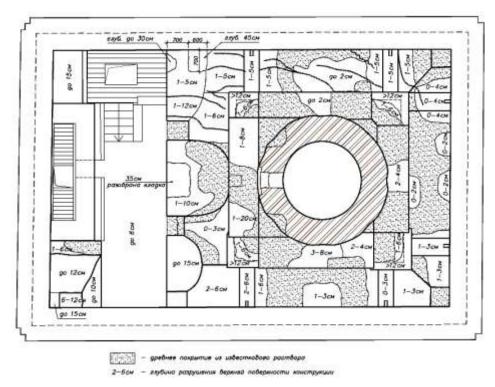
Схема утрат кладки поверху сводов покрытия четверика церкви
